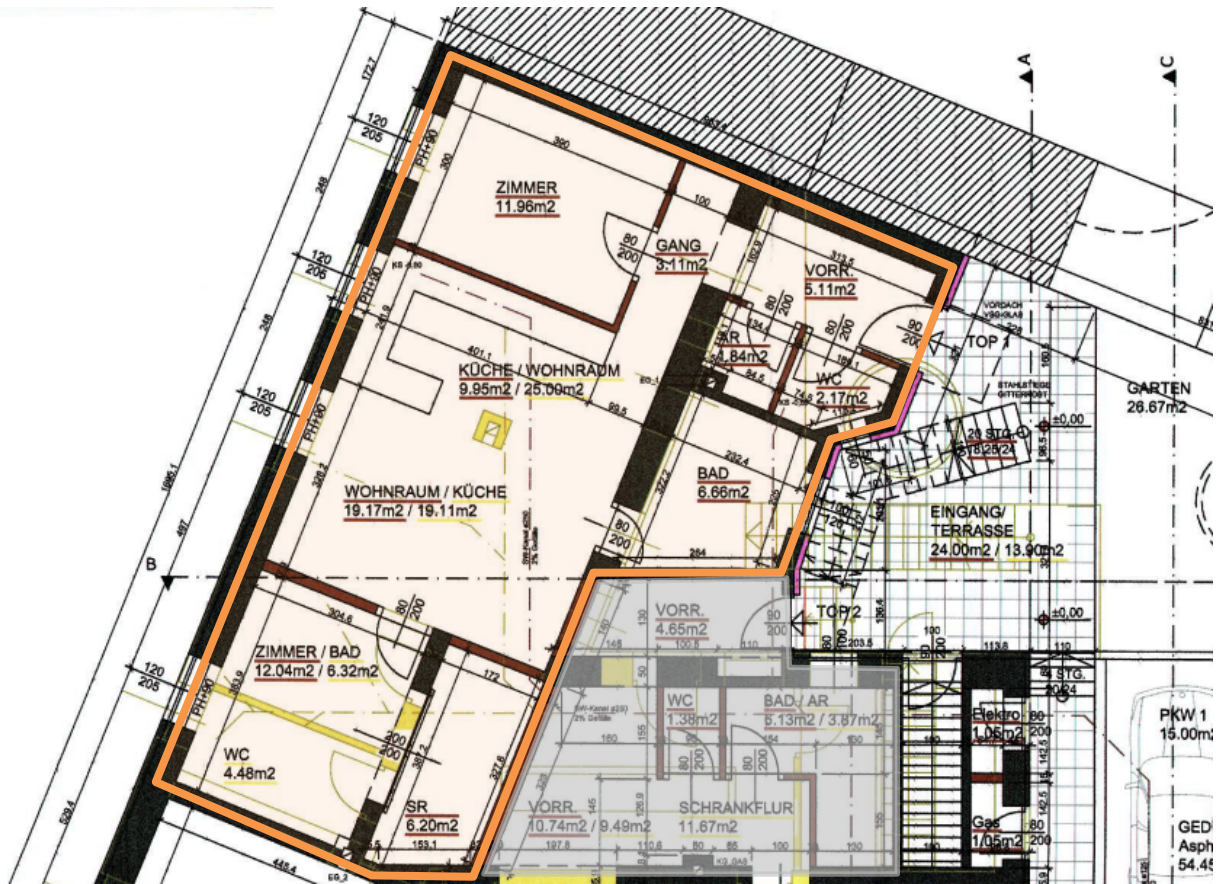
Grundriss Wohnung Top 1 (Auswechslungsplan 28.02.2014)
